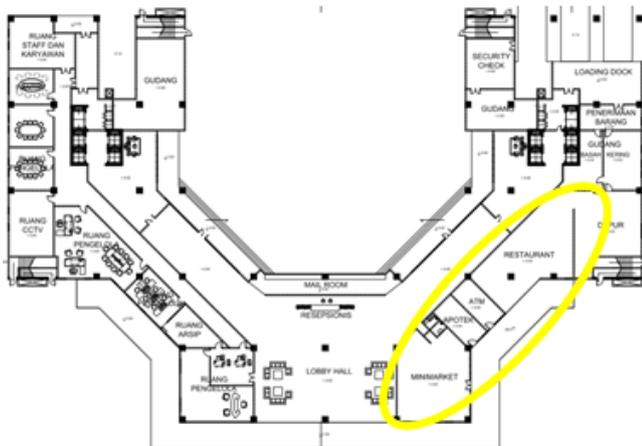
Denah Layoutplan. Sumber: penulis
